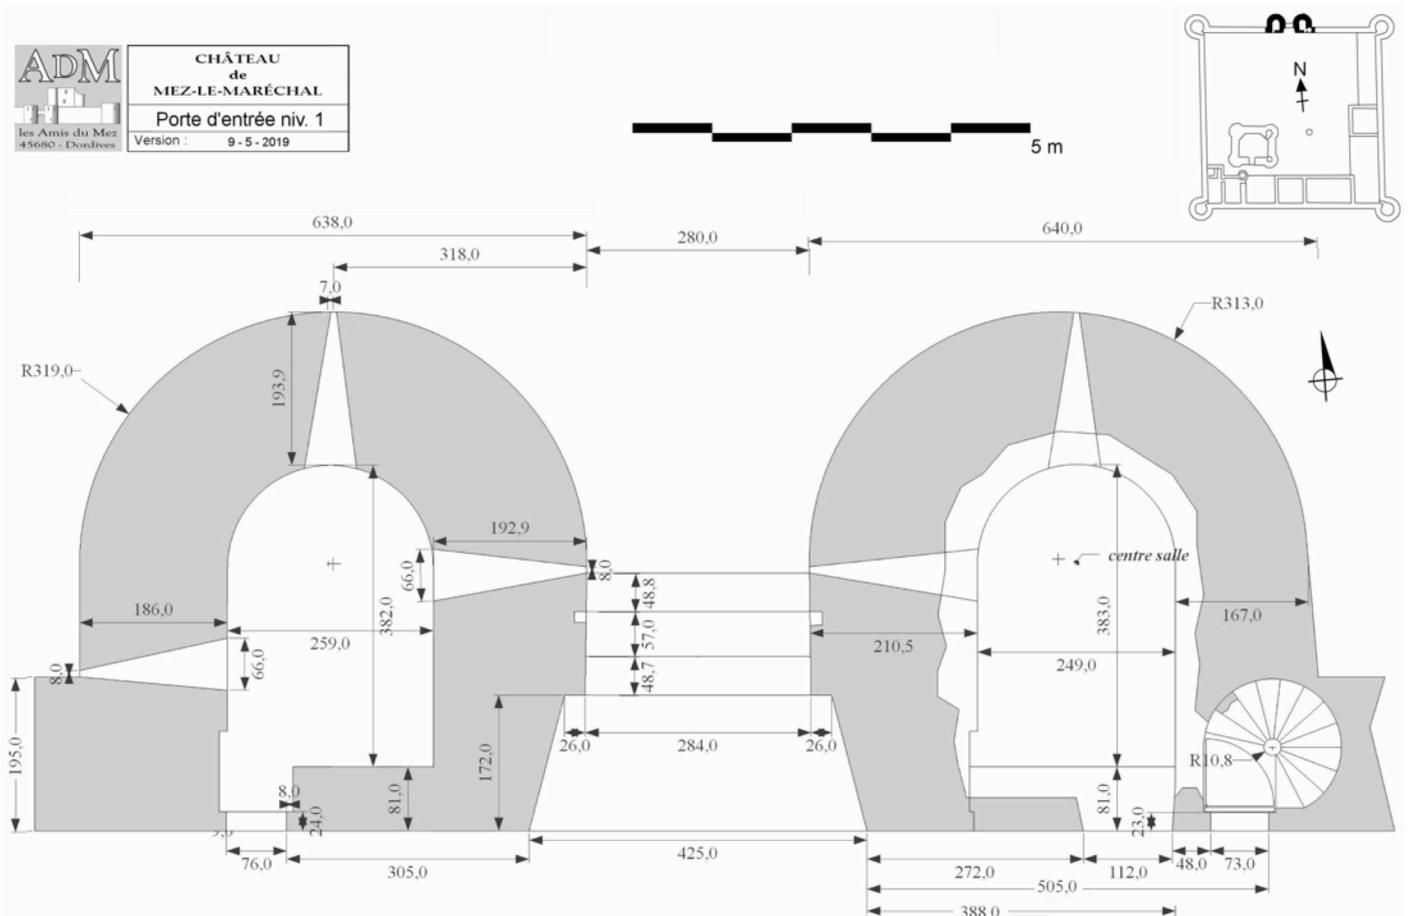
Plan de la porte à deux tours - Niveau 1 (DAO : Michel Piechaczyk / ADM).
